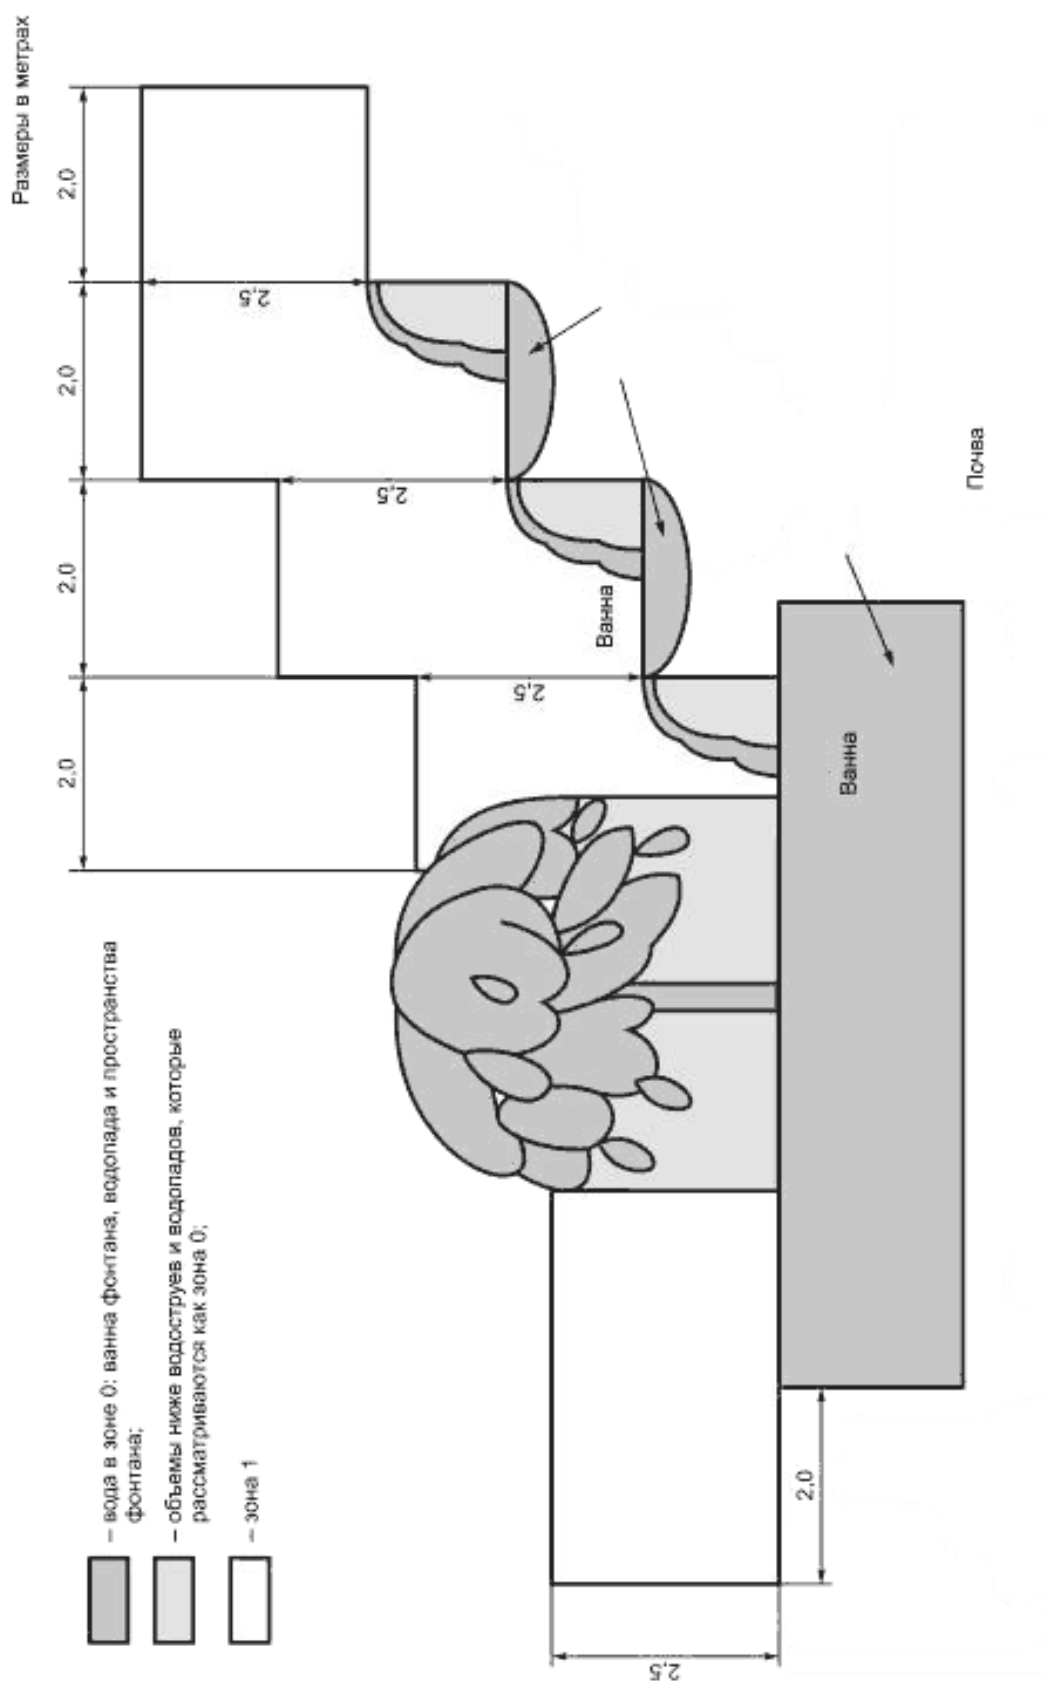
Пример определения зон фонтана (вид сбоку)
